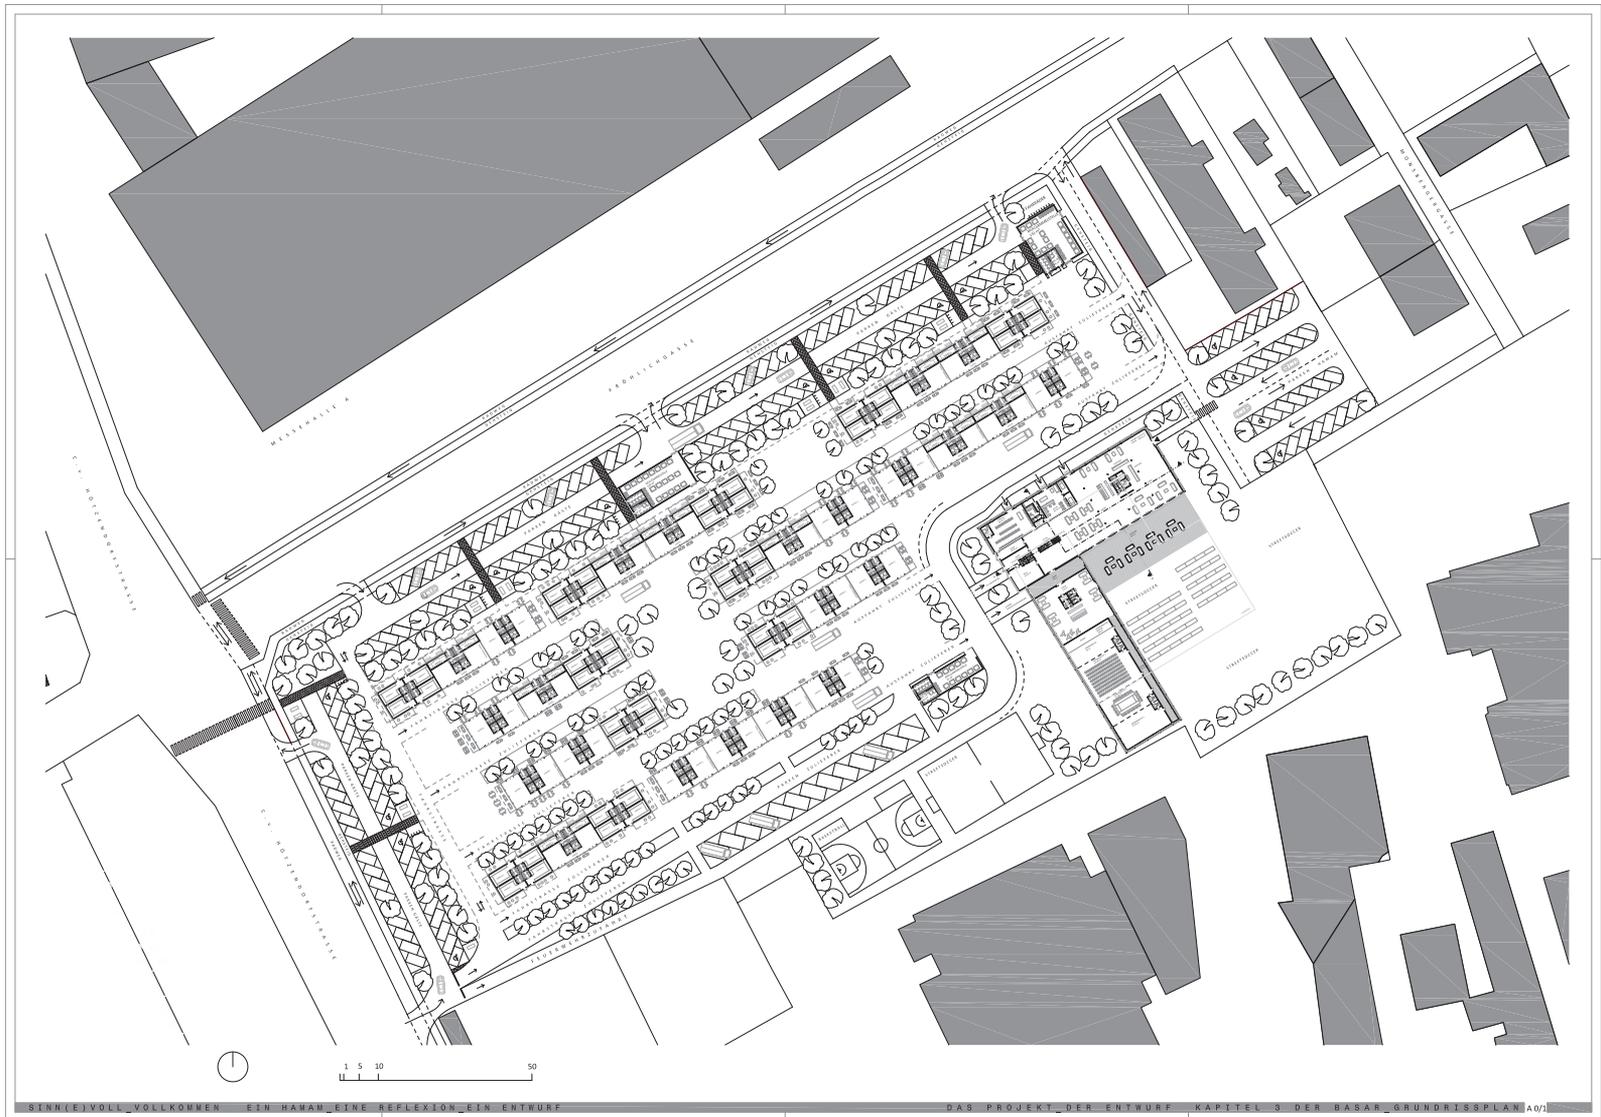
Abb. VI: Überblick Boxenanordnung im Grundrissplan (Maßstabslos)
